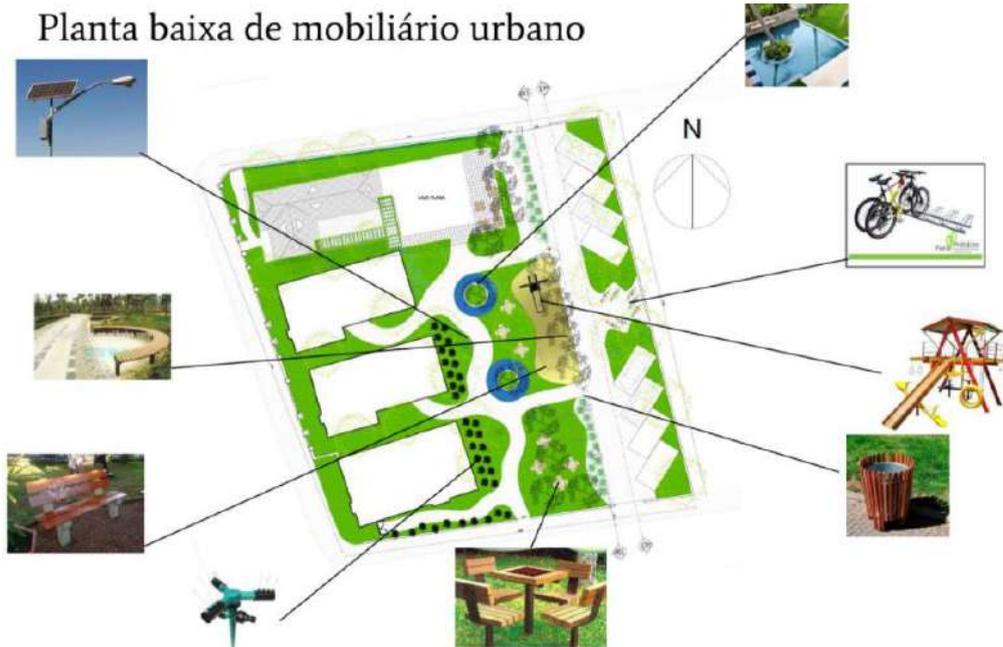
Planta baixa de mobiliário urbano - casa 724.
